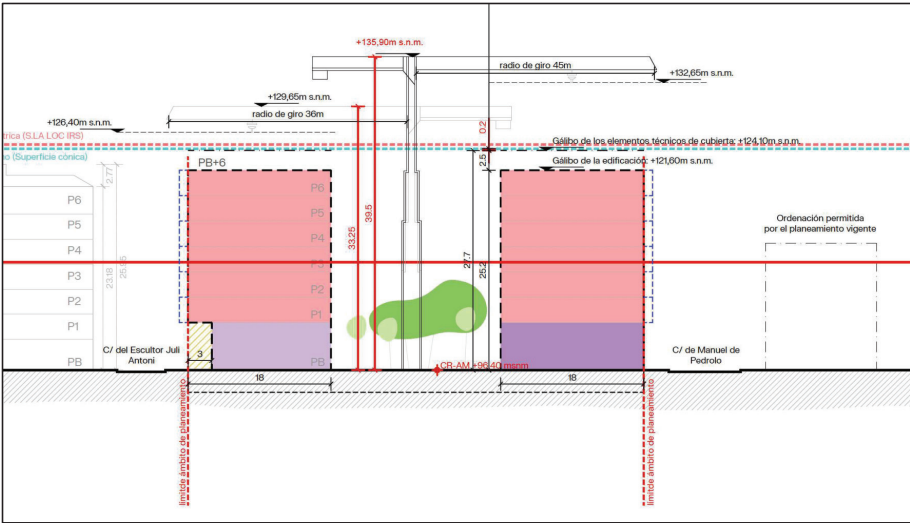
Perfil de las edificaciones y grúas, alturas y elevaciones. Edificios Sur.
